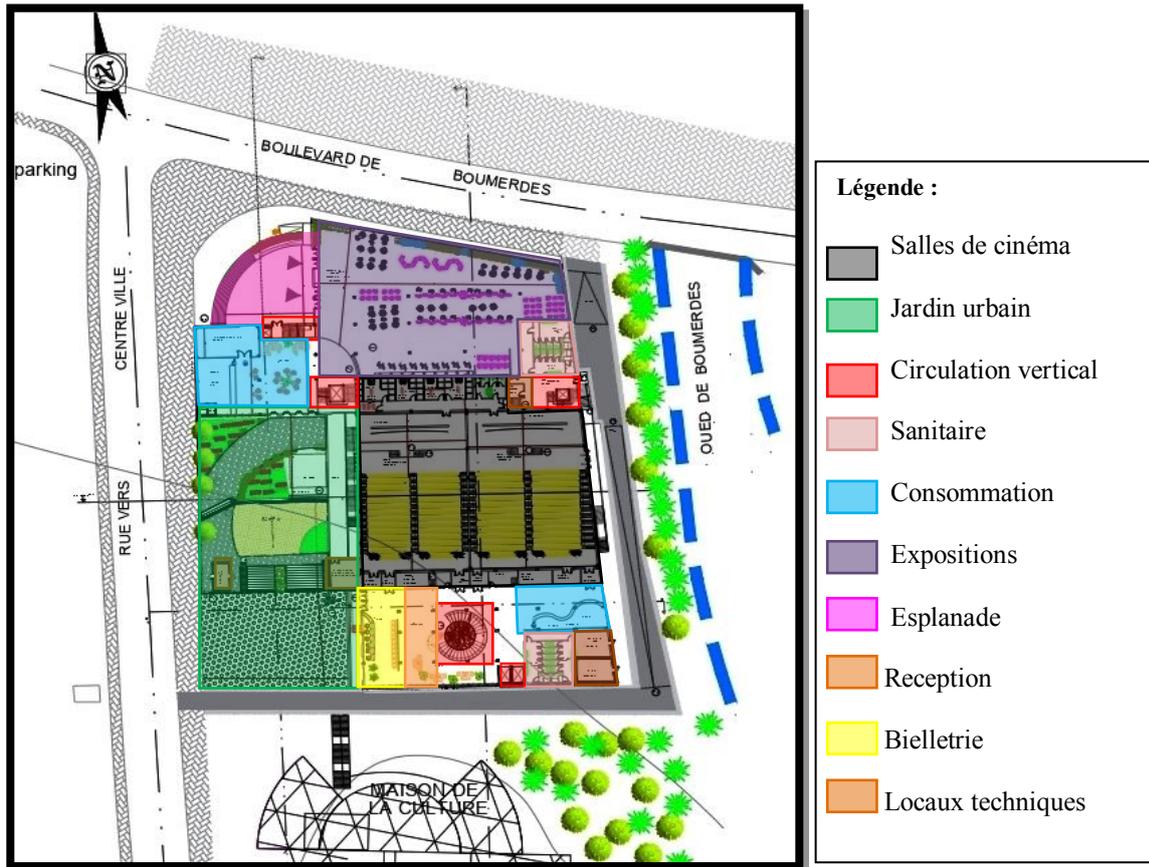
les différents espaces de plan de RDC, source : auteurs.
